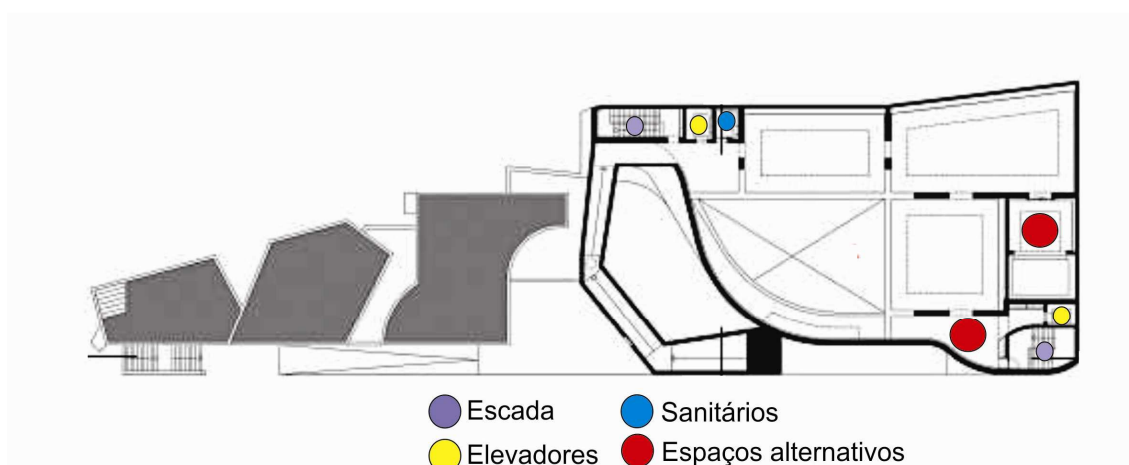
Planta baixa do quarto pavimento – espaços alternativos.
